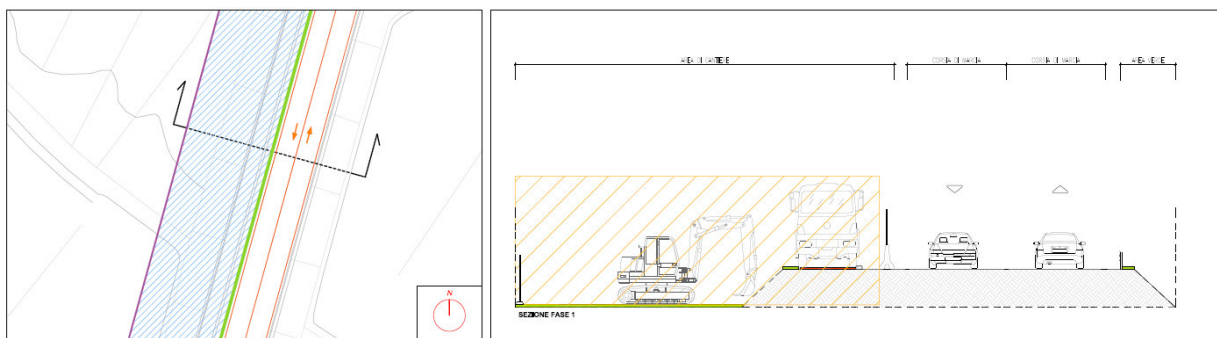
Tipologico cantiere in prossimità di strada Fase 1
